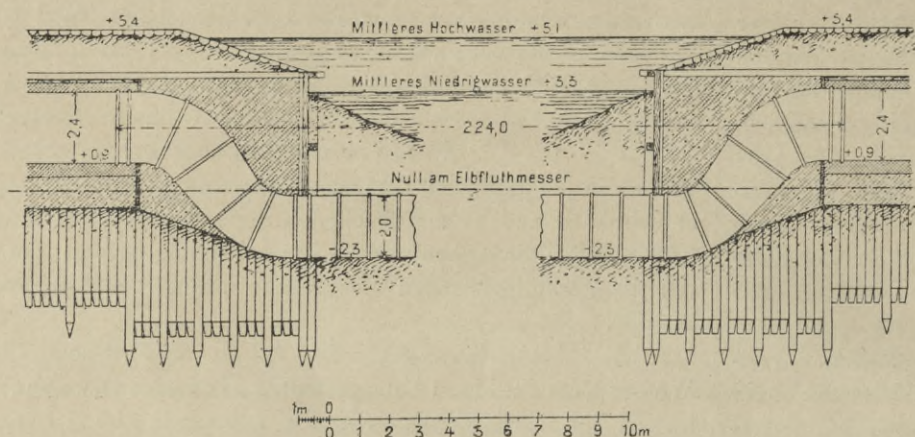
Eiserner Düker unter der Billwälder Bucht.
